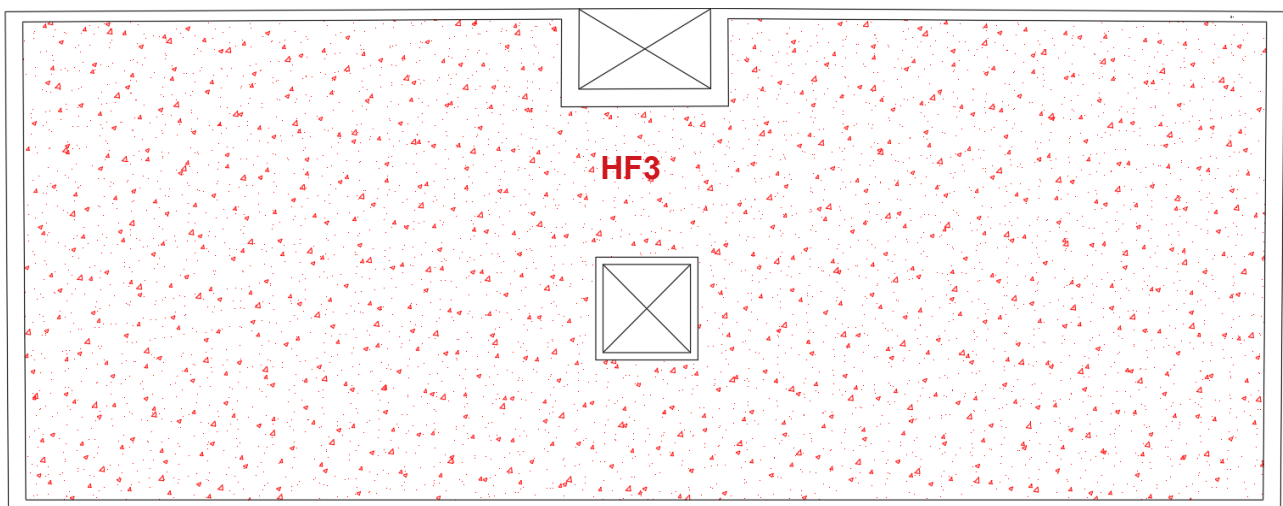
Localización Patología Humedad por Filtración Planta Cubierta (HF3).
